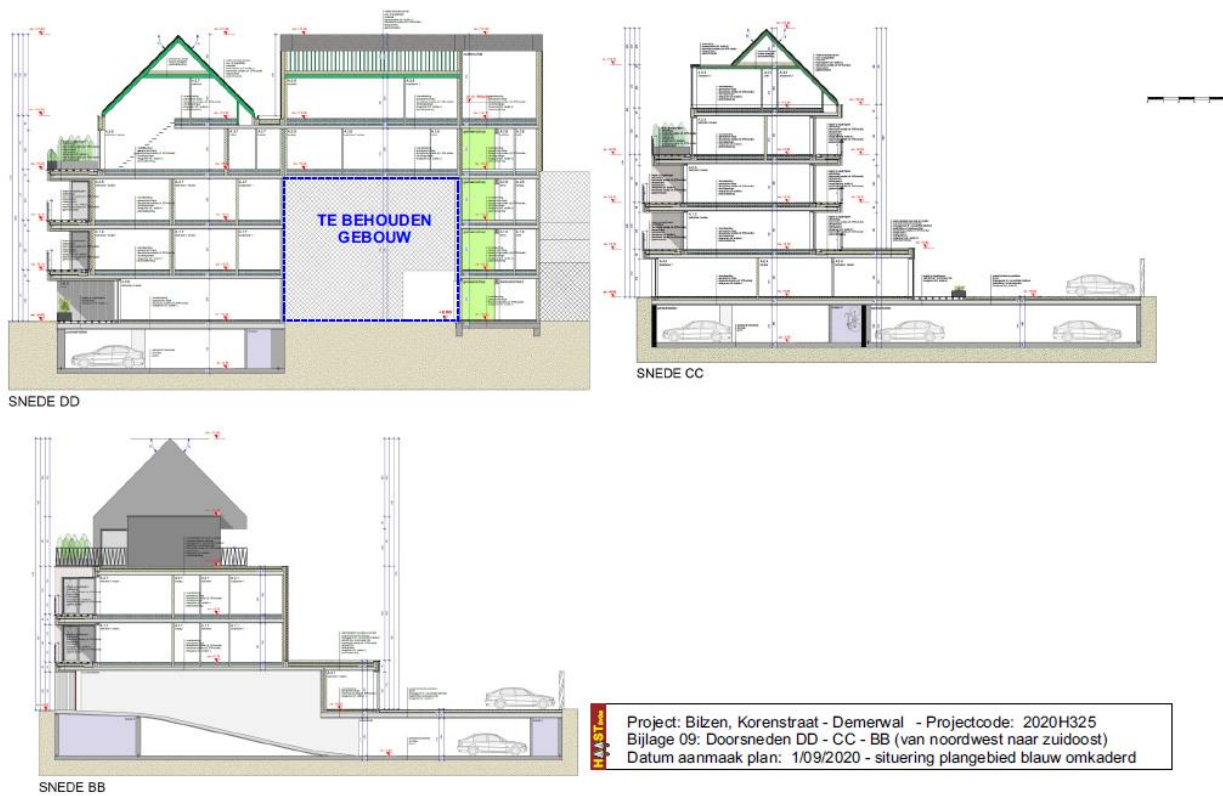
doorsneden DD – CC – BB (van noordwest naar zuidoost)
